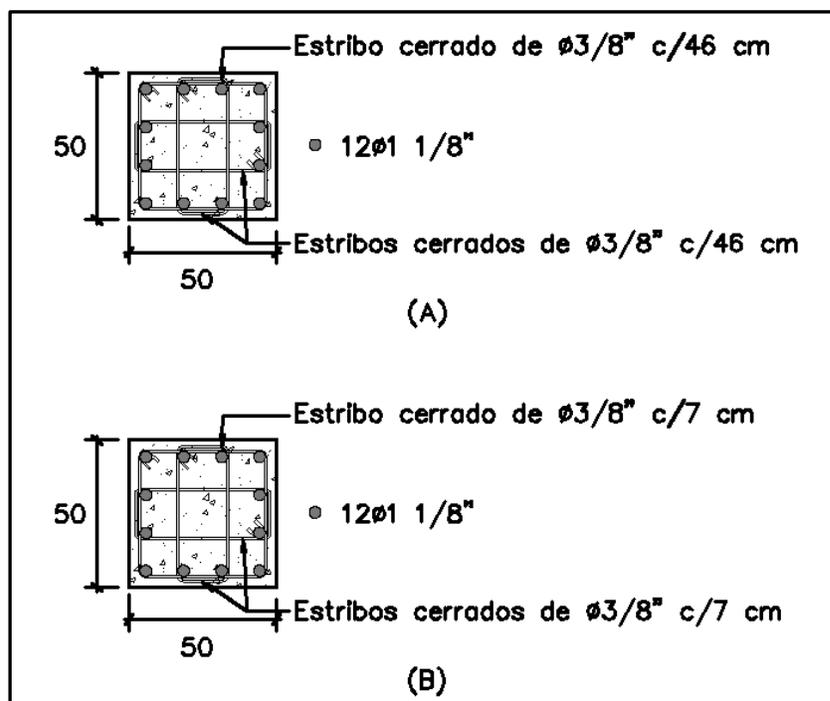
Detallado para CM2.(A) Cuevas y Fernández (2005). (B) ACI 318-14. Fuente: Autor.
